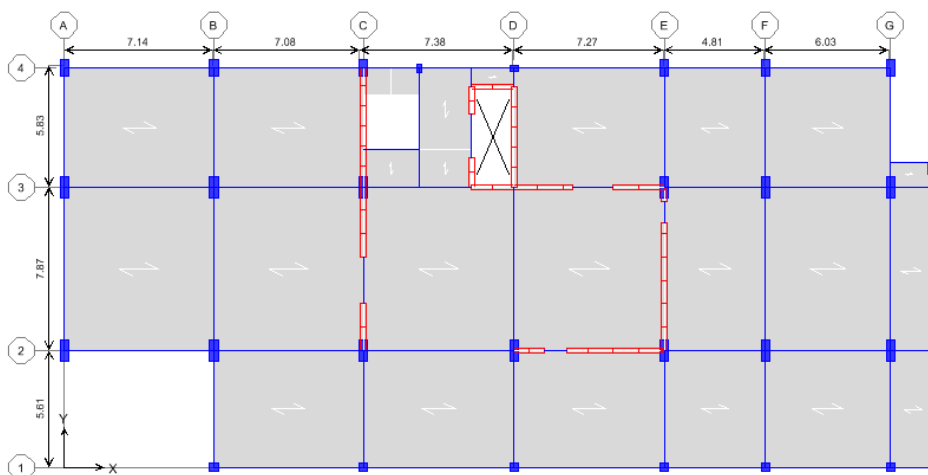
Planta estructural típica del 2do. y 3er. Piso
